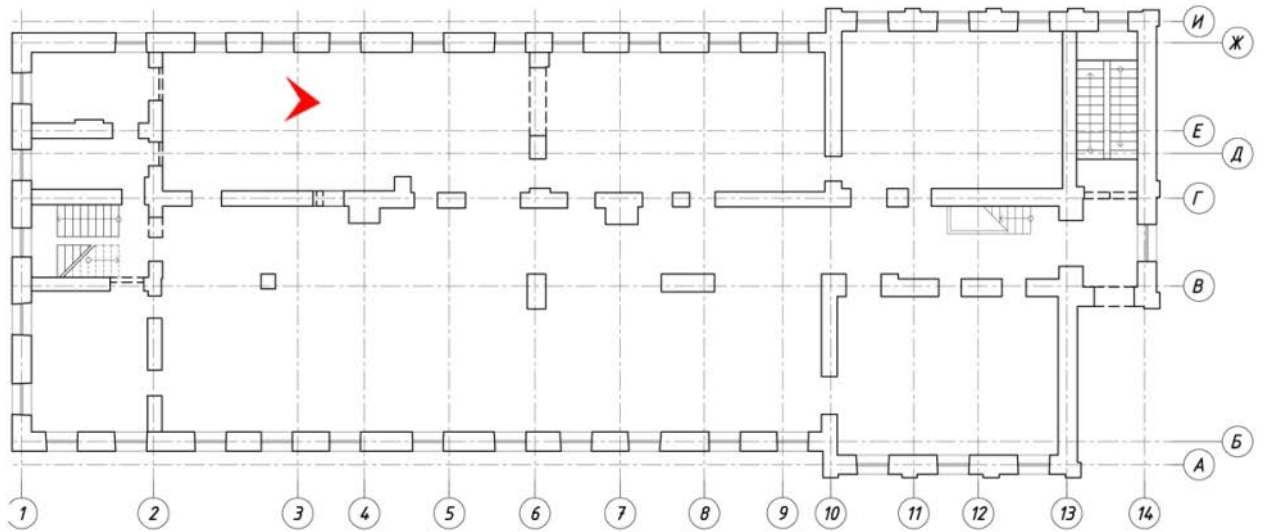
Помещение 2-го этажа в осях 2 – 10/Г – И.
